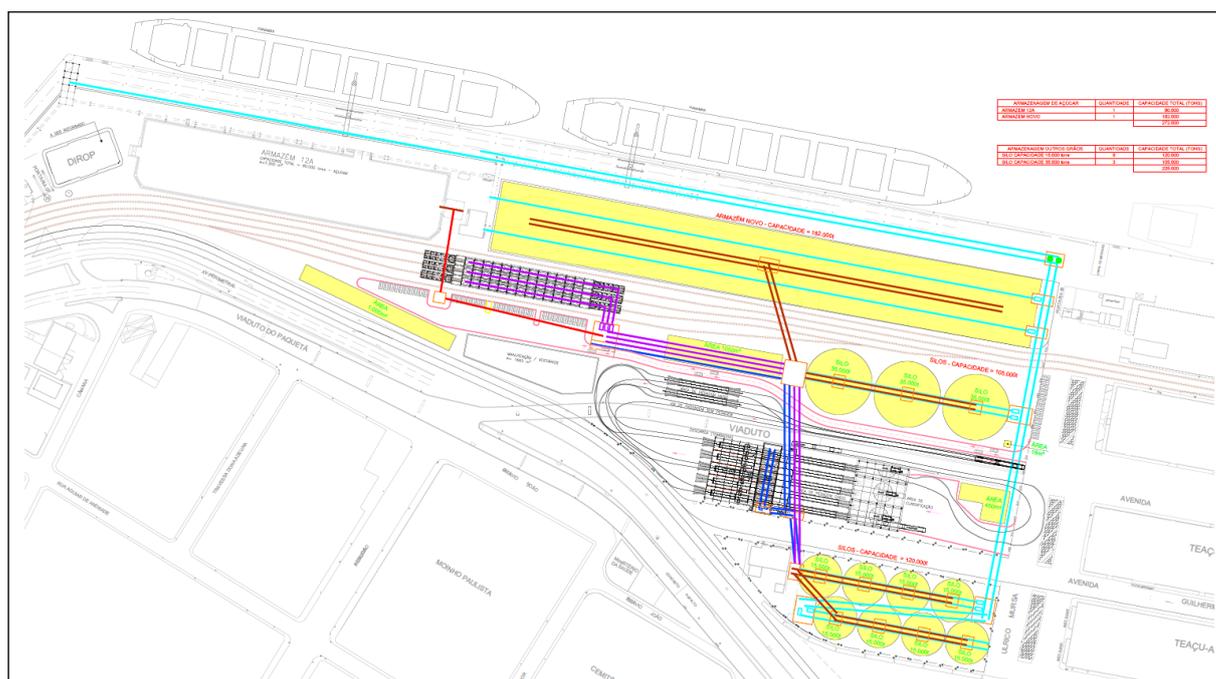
Layout do Terminal STS11 na Fase 2
